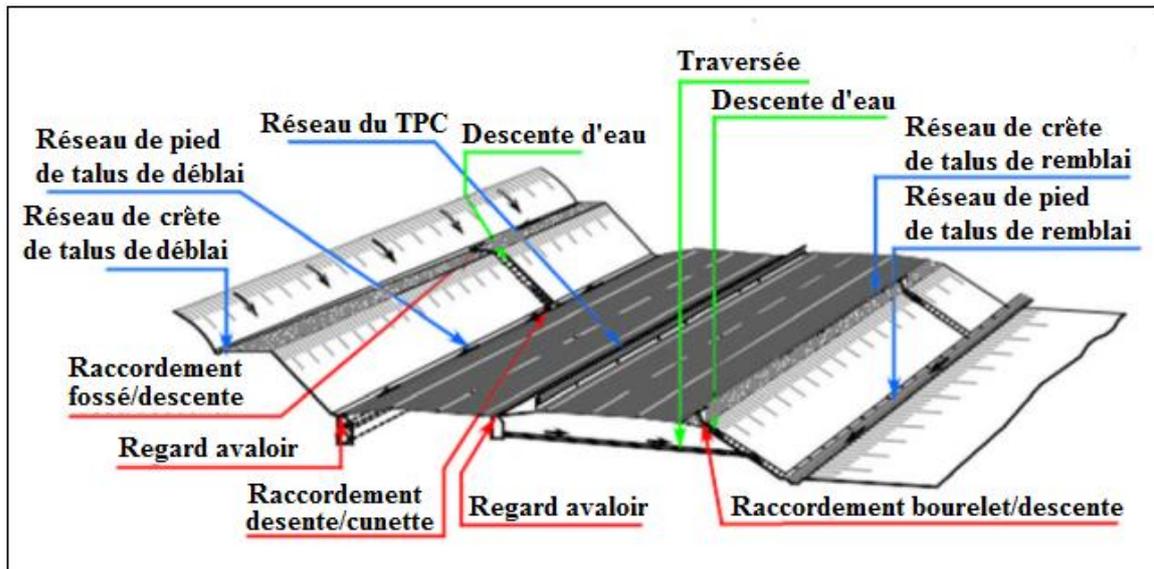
Élément d'assainissement de la plate forme d'une chaussée routière.
